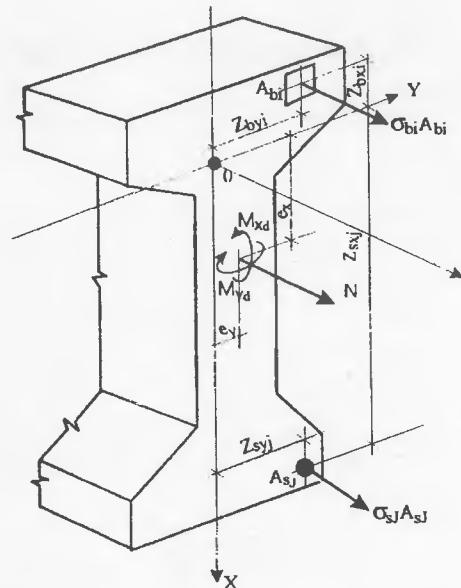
Расчетная схема нормального сечения железобетонного элемента
